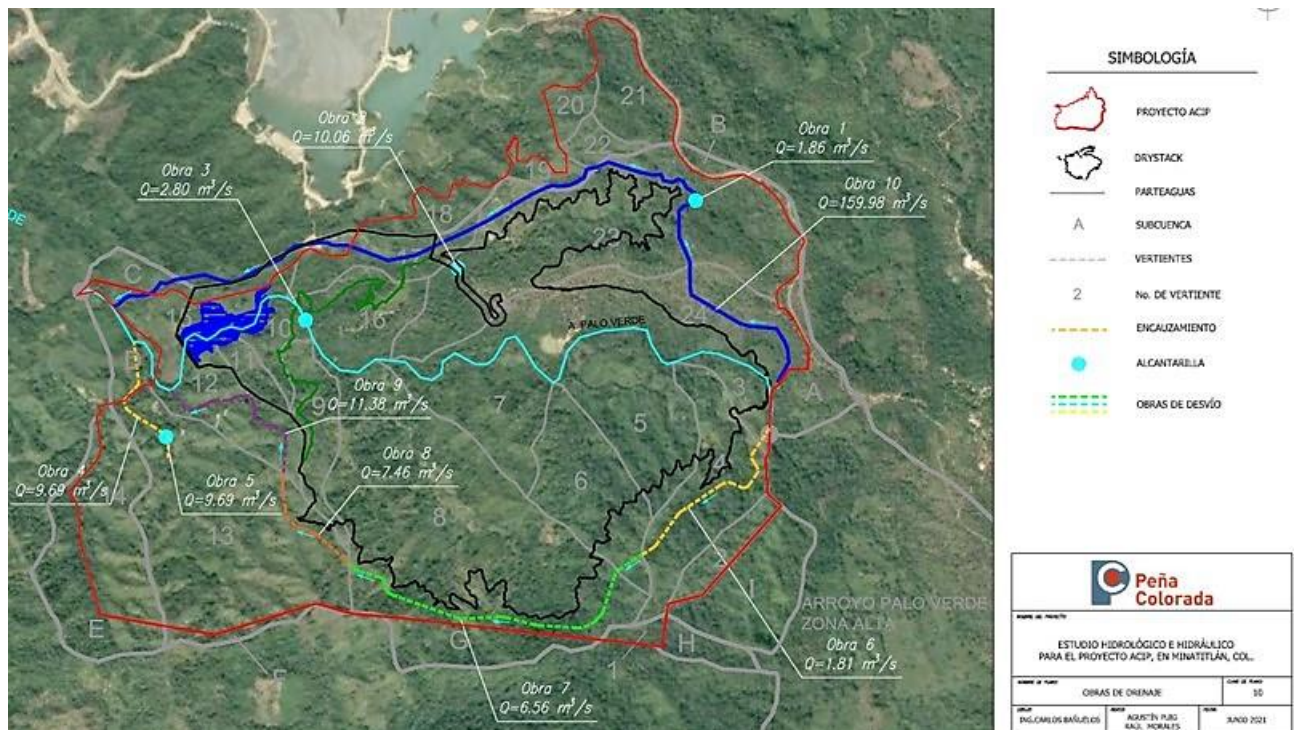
Distribución de las obras hidráulicas y de drenaje pluvial requeridos por el proyecto.
